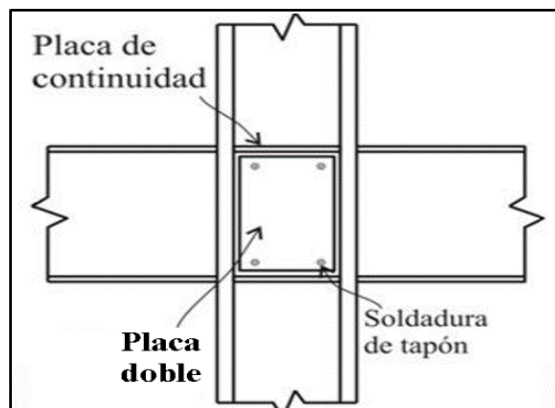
Placas dobles de refuerzo en la zona de panel con placas de continuidad.
